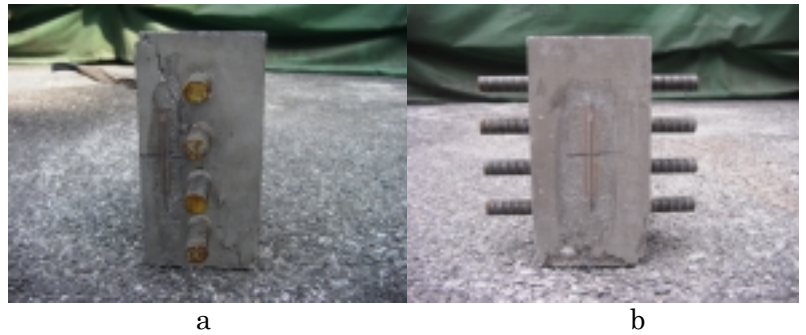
供試体の破壊形態 (a: 破壊面, b: 非破壊面)
